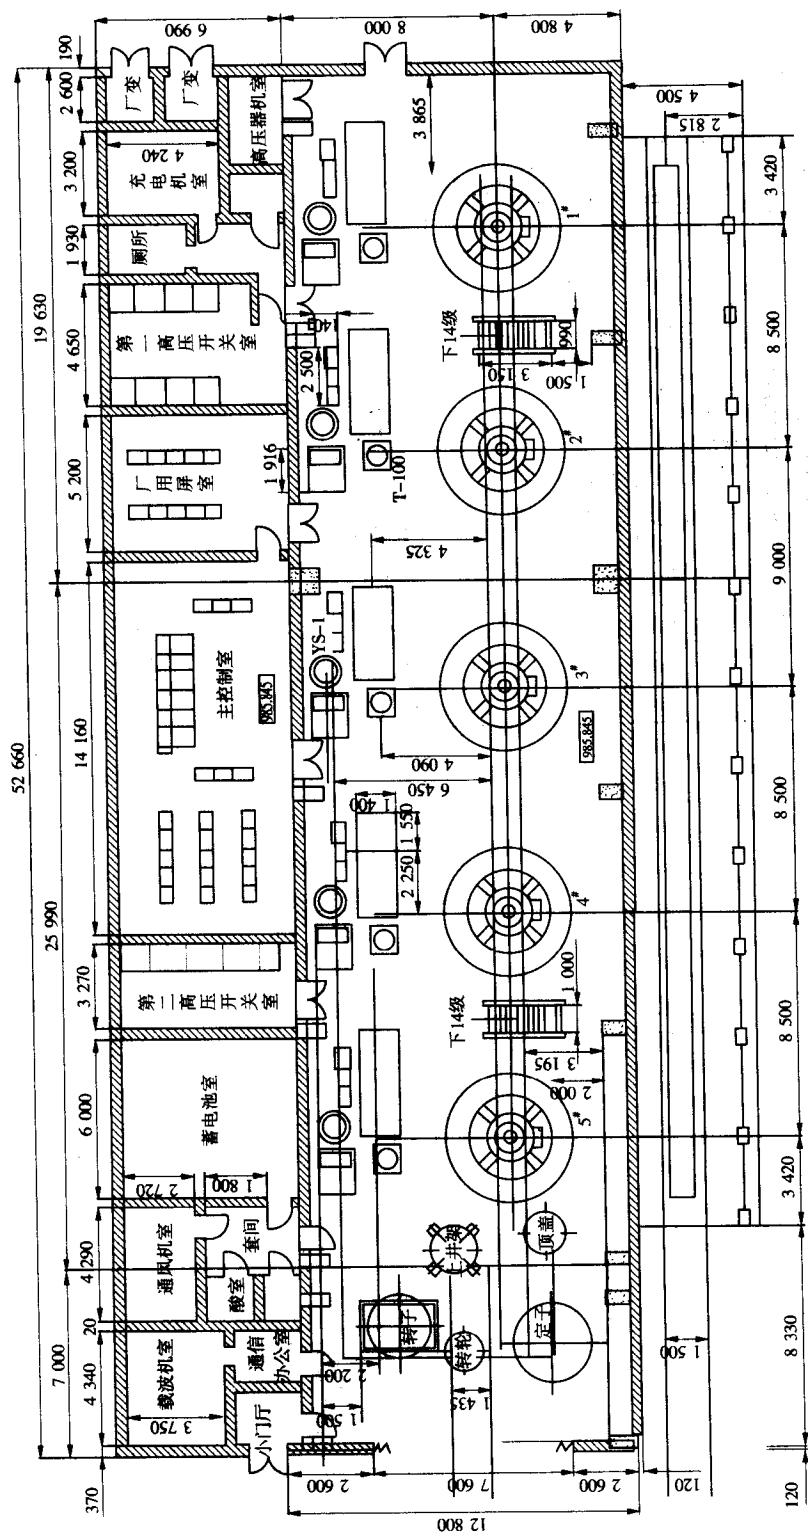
某电站厂房发电机层平面布置图(单位:mm)
